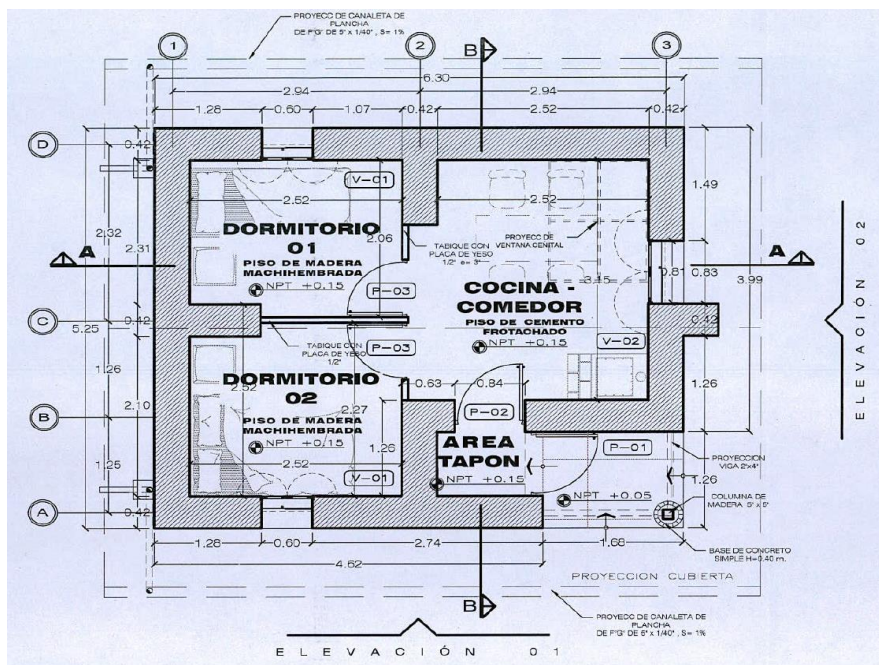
Plano de planta propuesta de vivienda rural PNVR
